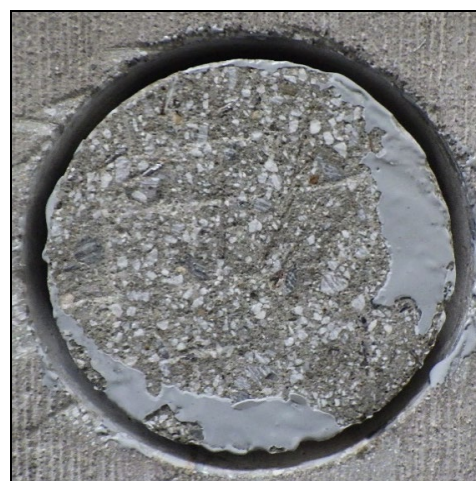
横浜ベイブリッジ 引張接着強度試験 試験後の状況 (その1)
